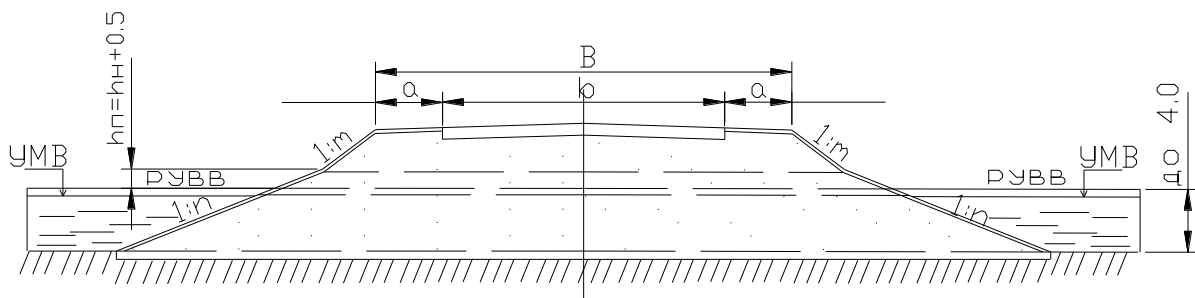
Поперечный профиль насыпи на пересечении водоемов.
